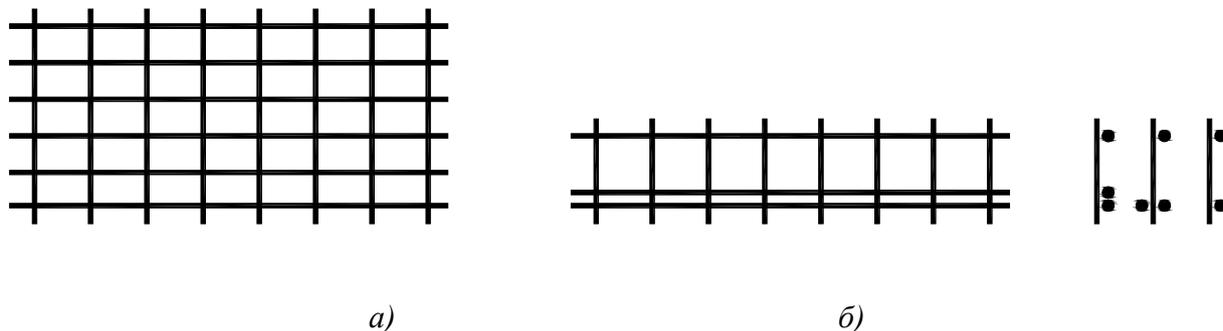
Арматурные сетки и каркасы: а – сетка; б – каркас
